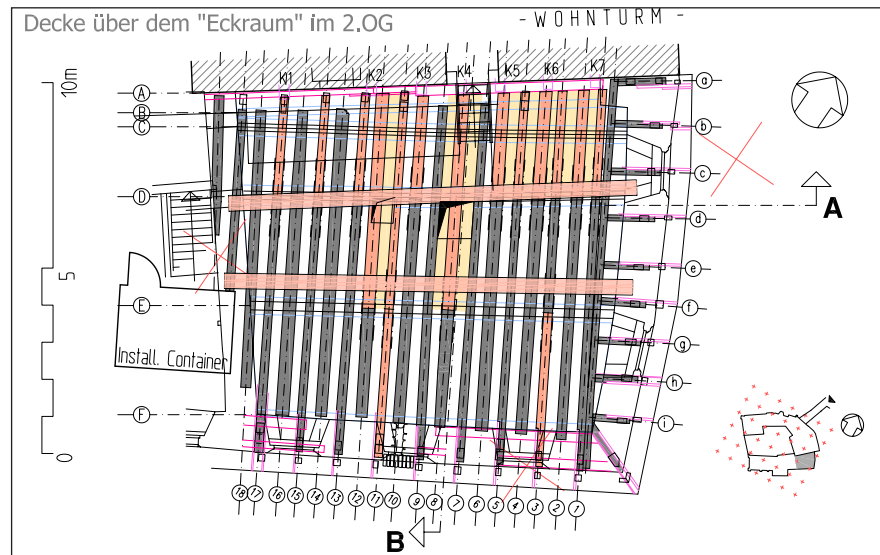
Decke über dem zweiten Obergeschoss am Anschluss des Südflügels an den Wohnturm, Grundriss der Bestandsaufnahme mit Einzeichnung der geplanten Überzüge; rote Eintragung = erneuerte Balken, gelbe Eintragung = erneuerte Bohlen.
